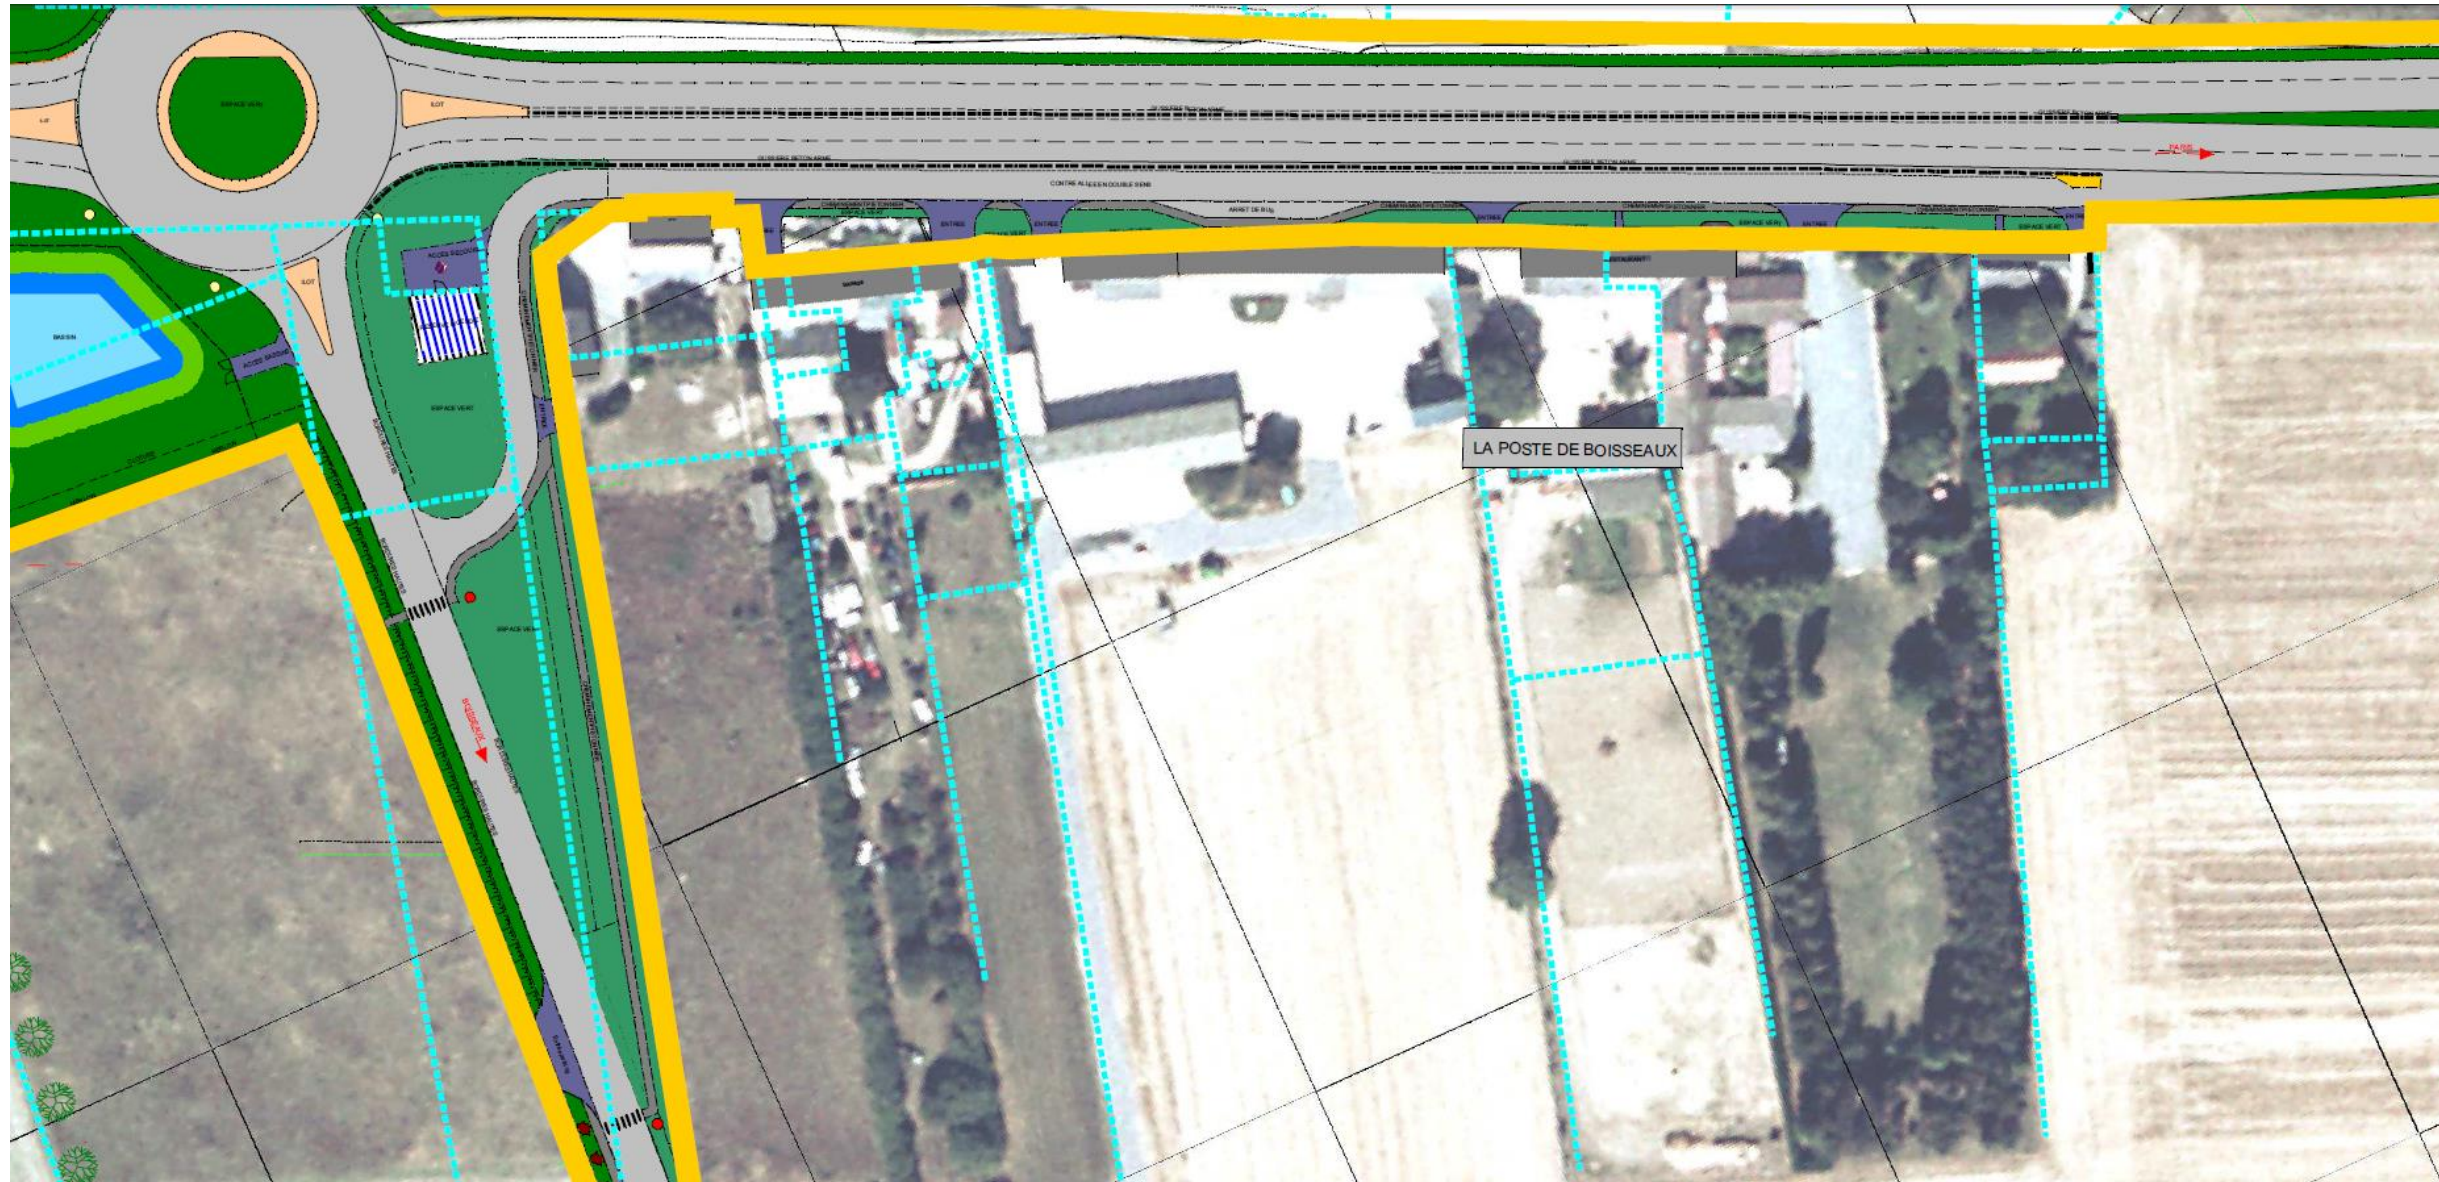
Accès à la contre-allée desservant le hameau de la Poste de Boisseaux.
